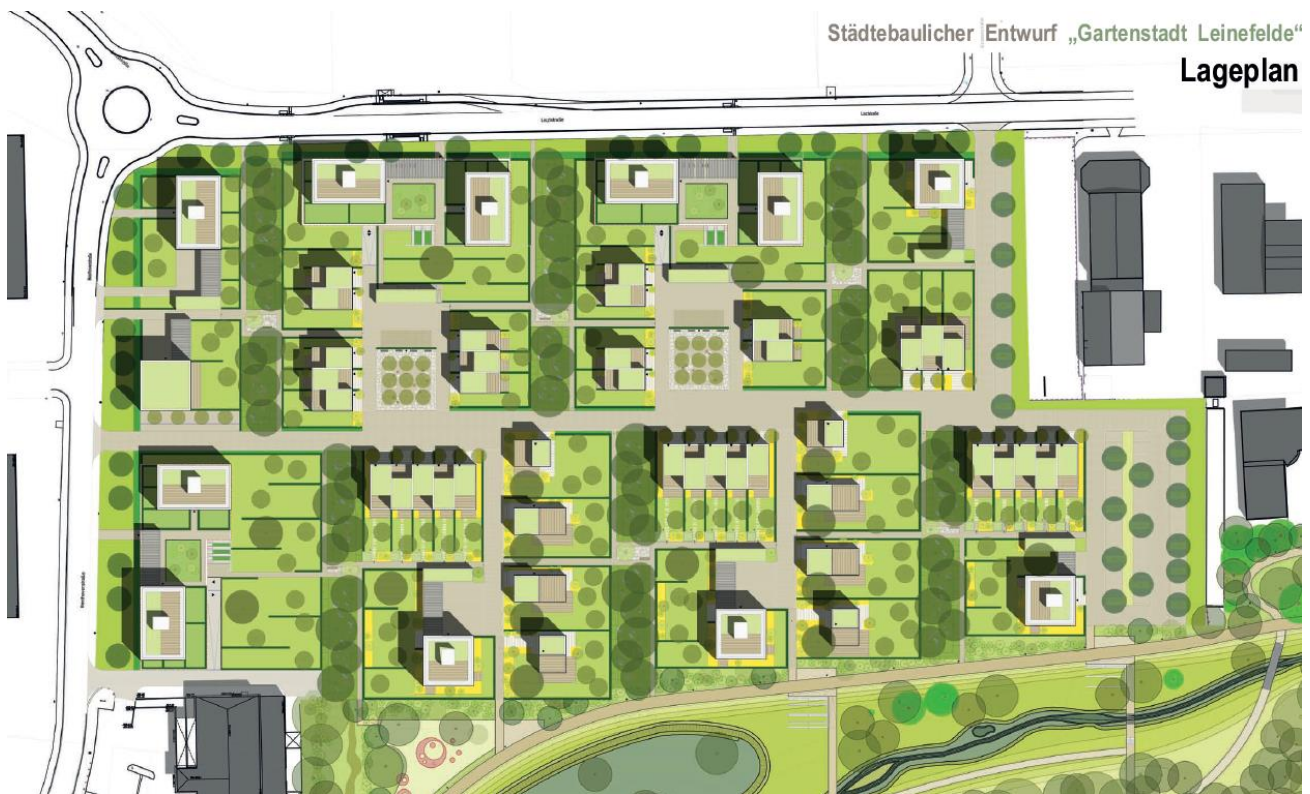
Lageplan Städtebaulicher Entwurf , Stand 08/2021, arge | LGS 2024
